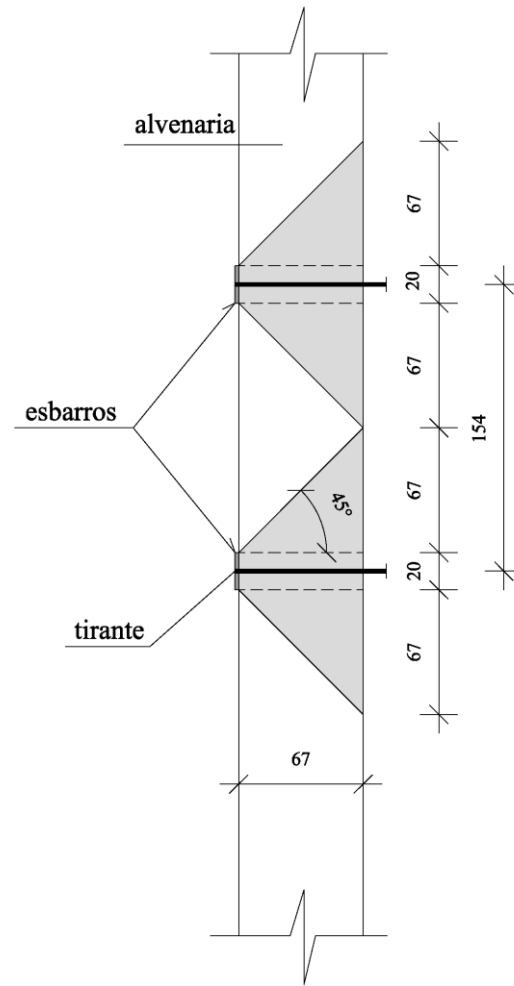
Detalhe do espaçamento dos tirantes, em planta (medidas em centímetros).
